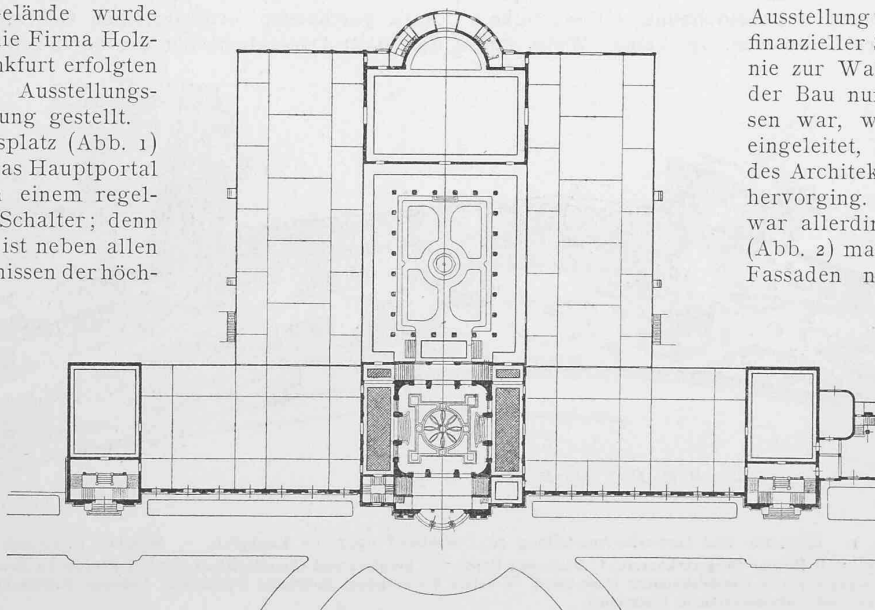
Die Kunsthalle. — Grundriss. — Masstab 1:1200.
